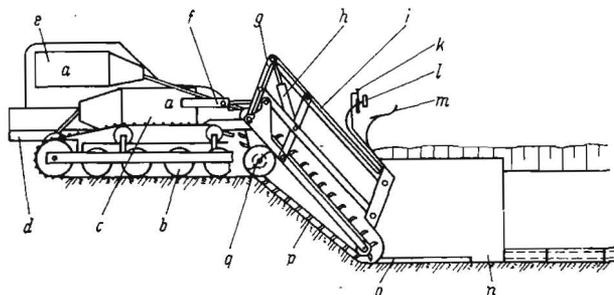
Schema eines Fräsketten-Dränggrabenbaggers; a Motor und Getriebe, b Laufwerk, c Fahrtrieb, d Maschinenrahmen, e Werkzeugantrieb, f Aushubzylinder, g Werkzeuganlenkung, h Steuerzylinder, i Steuerkabel, k Peilstab, l Steuerkasten, m Maschinensitz (seitlich), n Rohrverlegekasten, o Schleifschuh, p Fräskette, q Querförderschnecke
